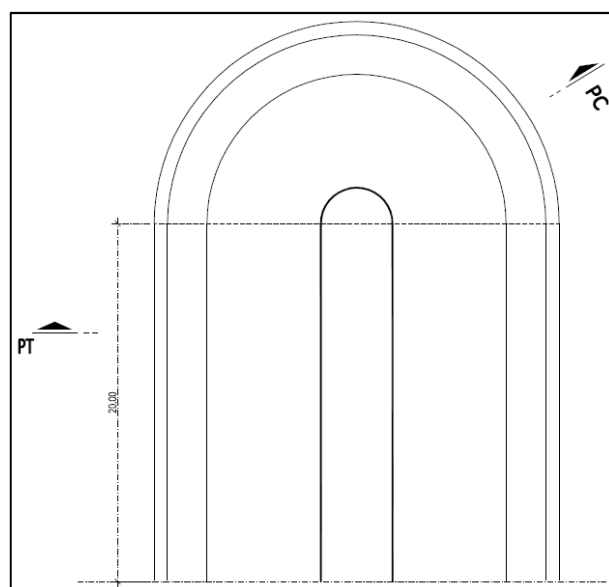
Troço do Centro Azul – Planta do esporão (fonte: APA, fevereiro de 2014)
